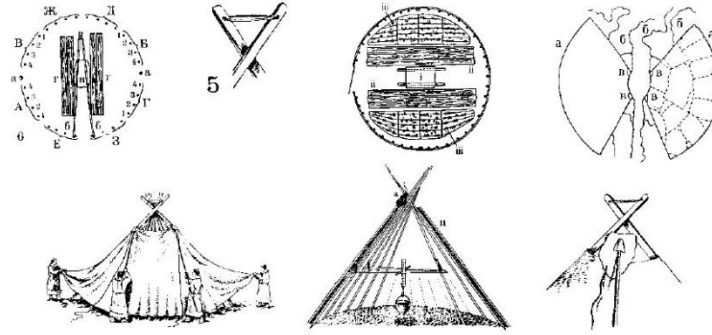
Yurd çadırı planı (Oliver, 2010)
